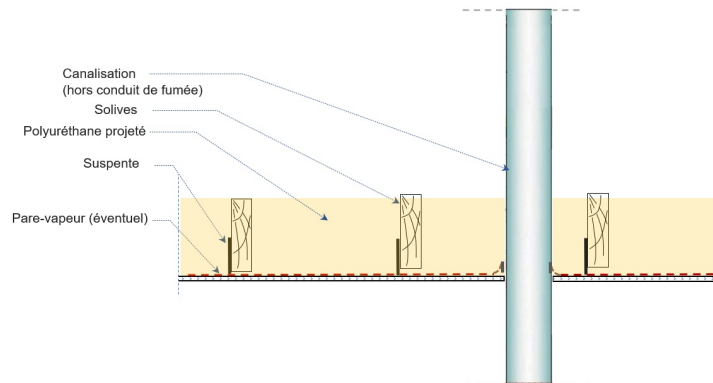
Traversée d'éléments (autres que conduits de fumée)
